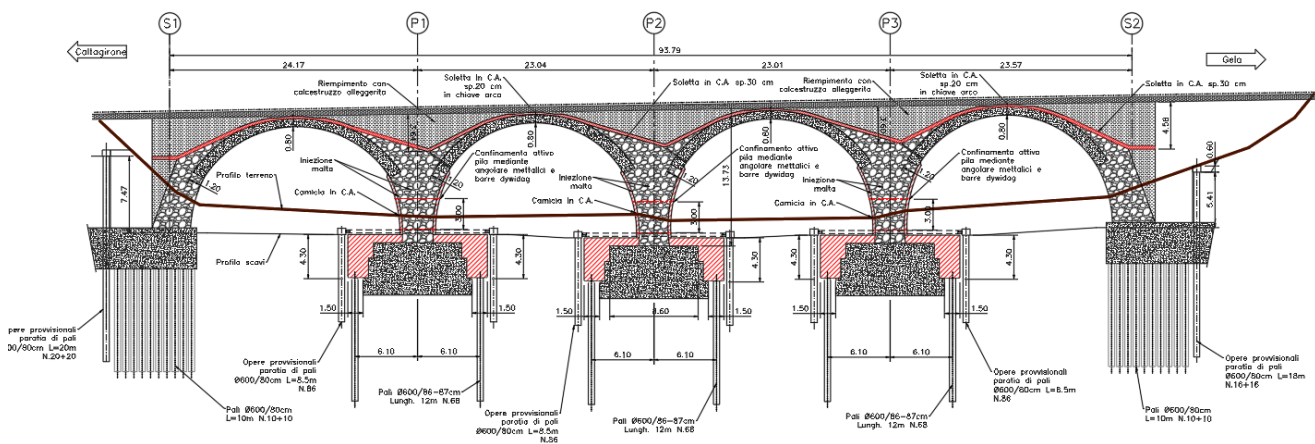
Sezione longitudinale viadotto tipo con quadro d'assieme interventi;
